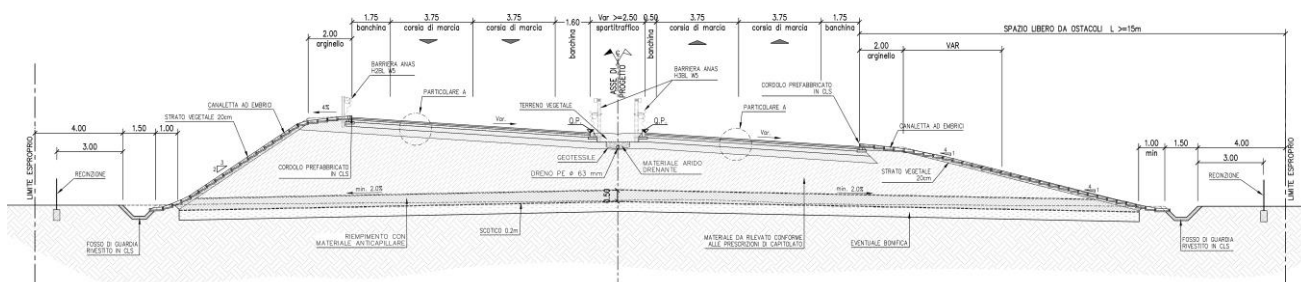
Sezione tipo in rilevato dell'asse principale con corsia di diversione e allargamento per visibilità
